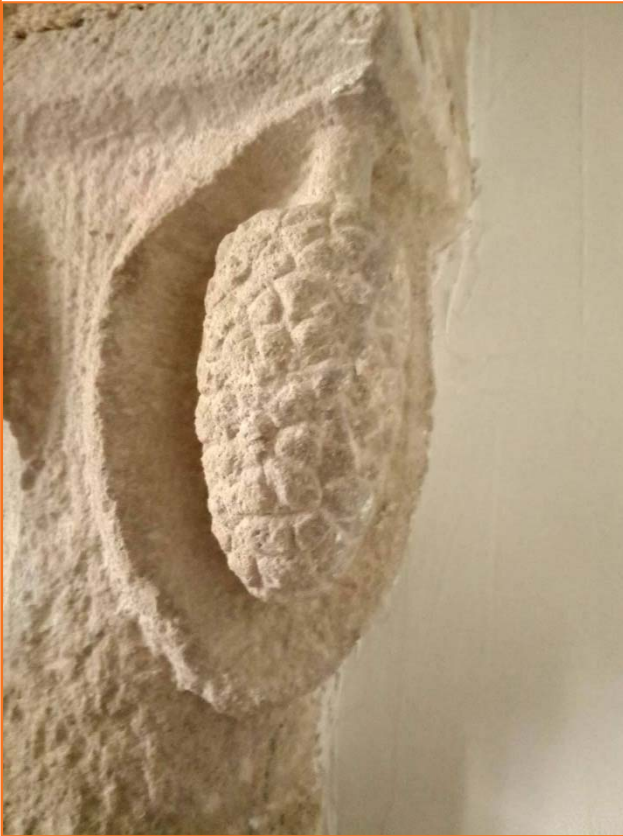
Detall d'una pinya del capitell de la finestra UE 122. Planta 2.
